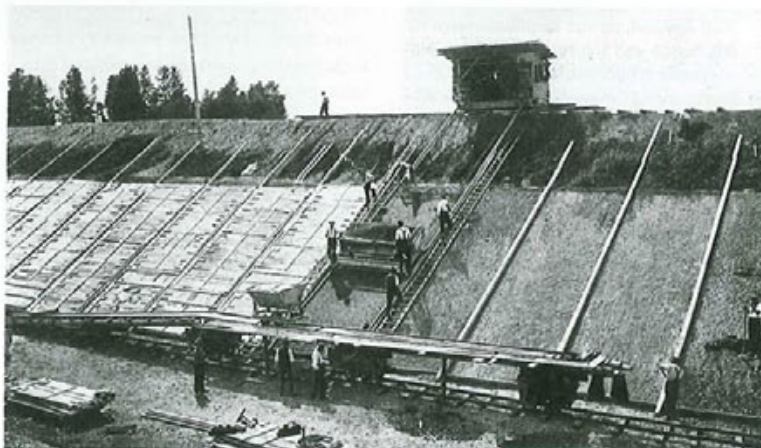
Betonierung der Böschungsbekleidung mit dem Kopperhofer'schen Apparat.
